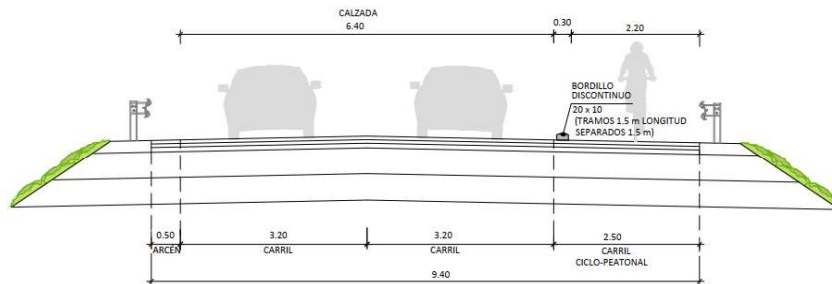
SECCIÓN TIPO DE LA CV-50 BAJO AP-7.
